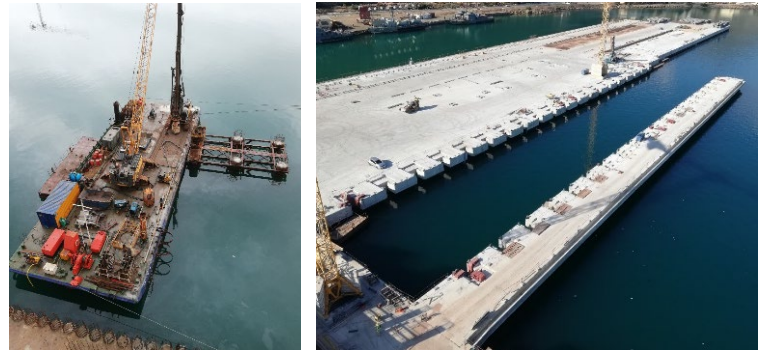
Execução das estacas de fundação e da estrutura de reação offshore para suspensão da plataforma elevatória
